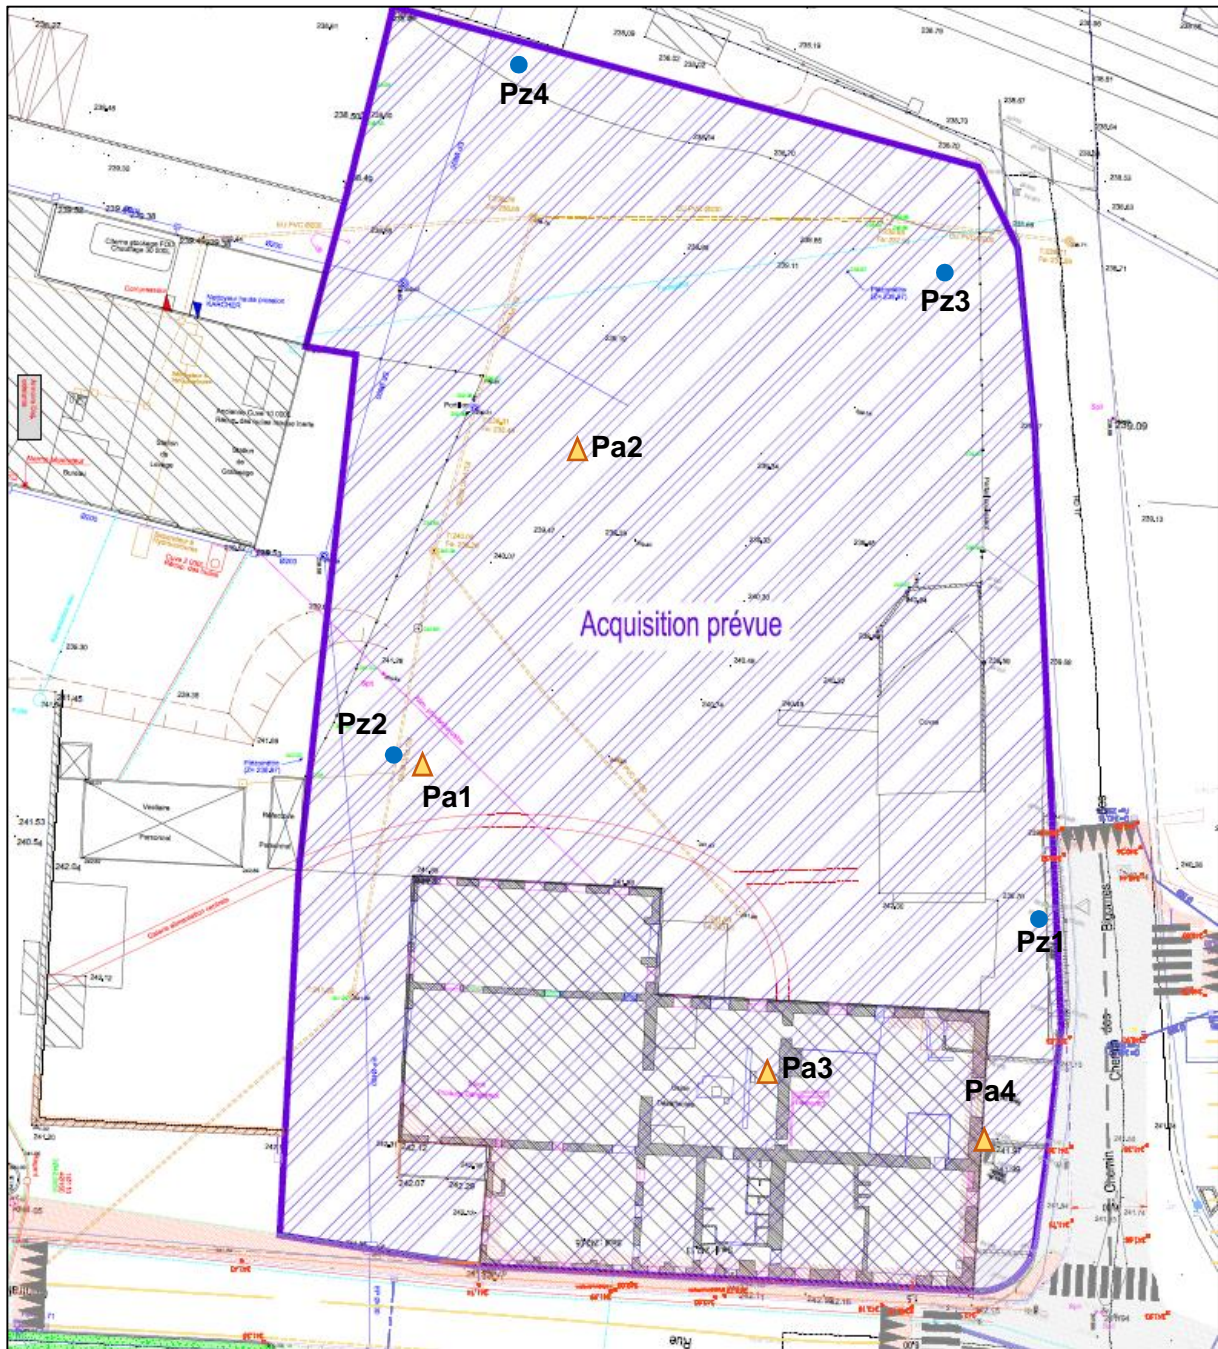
Localisation des piézaires et piézomètres au droit du site (Fond de plan EIFFAGE ROUTE – 21/09/2017)
